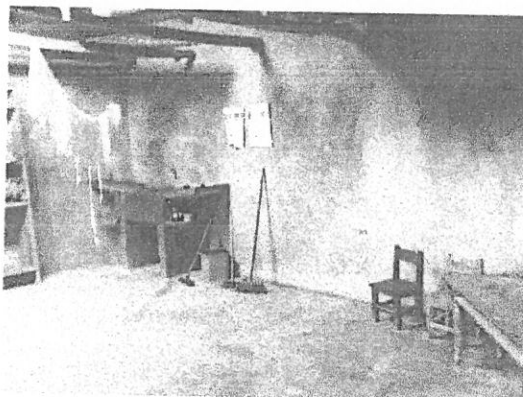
Interior de almacén y lavandería estructuras en regular estado.
